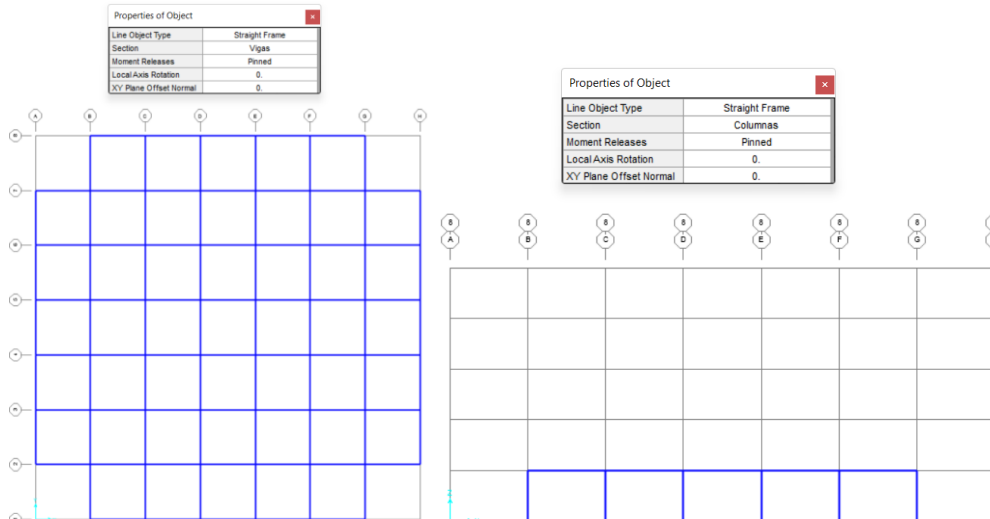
Dibujo de vigas y columnas del primer piso de la estructura
